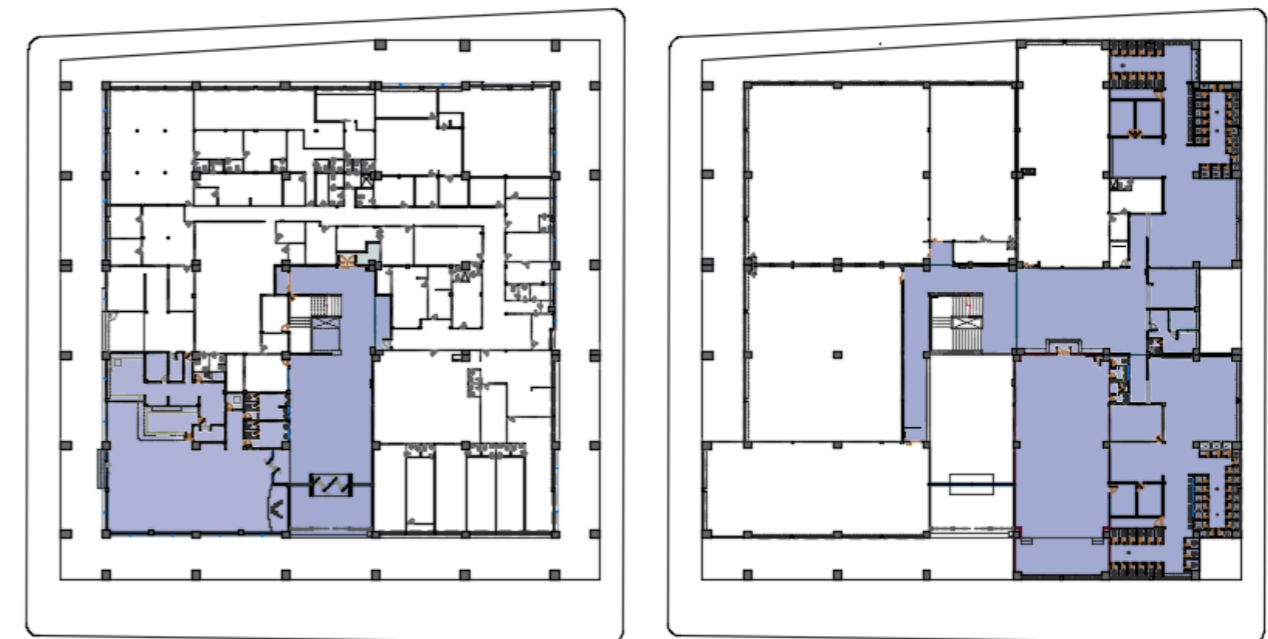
planta baja y alta del Polideportivo Huancavilca.
